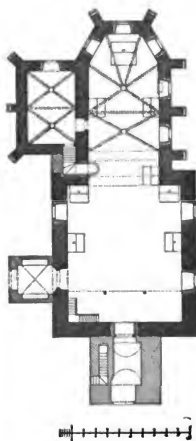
Bošilec. Grundriss der Kirche
